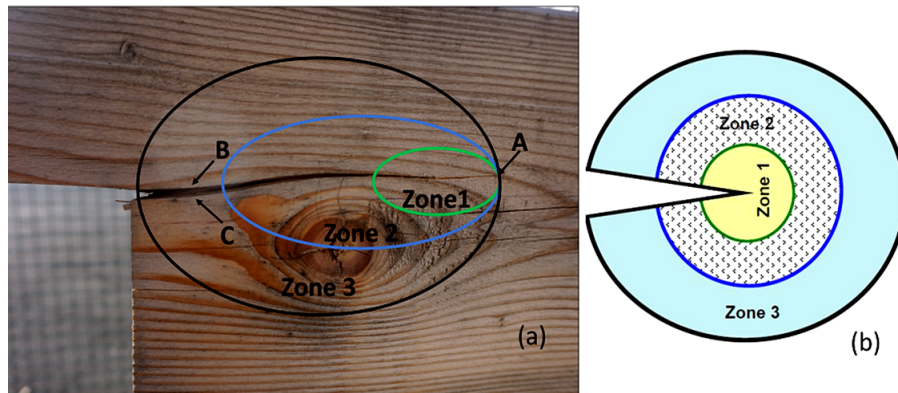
Présentation des différentes zones de fissuration : (a) illustration sur une pièce en bois de sapin blanc, (A) pointe de fissure , (B, C) lèvres d'une fissure (b) ; Schémas [Moutou Pitti (2008)].
